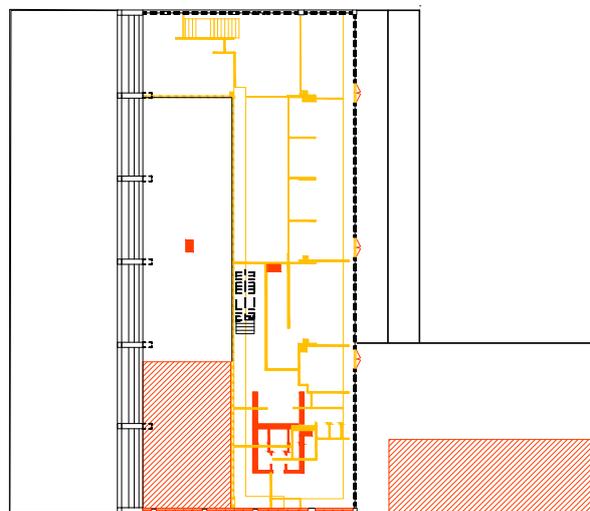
Planimetria demolizioni e costruzioni - Piano secondo.
